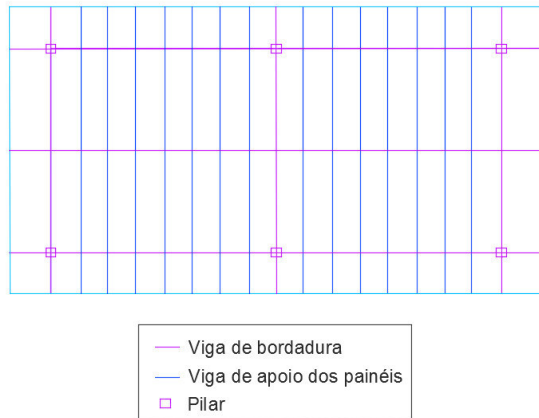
Representação em planta da estrutura de apoio da cobertura
